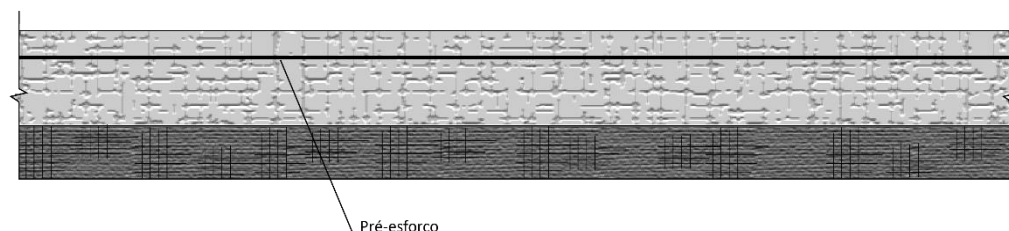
Perfil de pavimento rígido de betão pré-esforçado (adaptado de OLIVEIRA, 2000)
